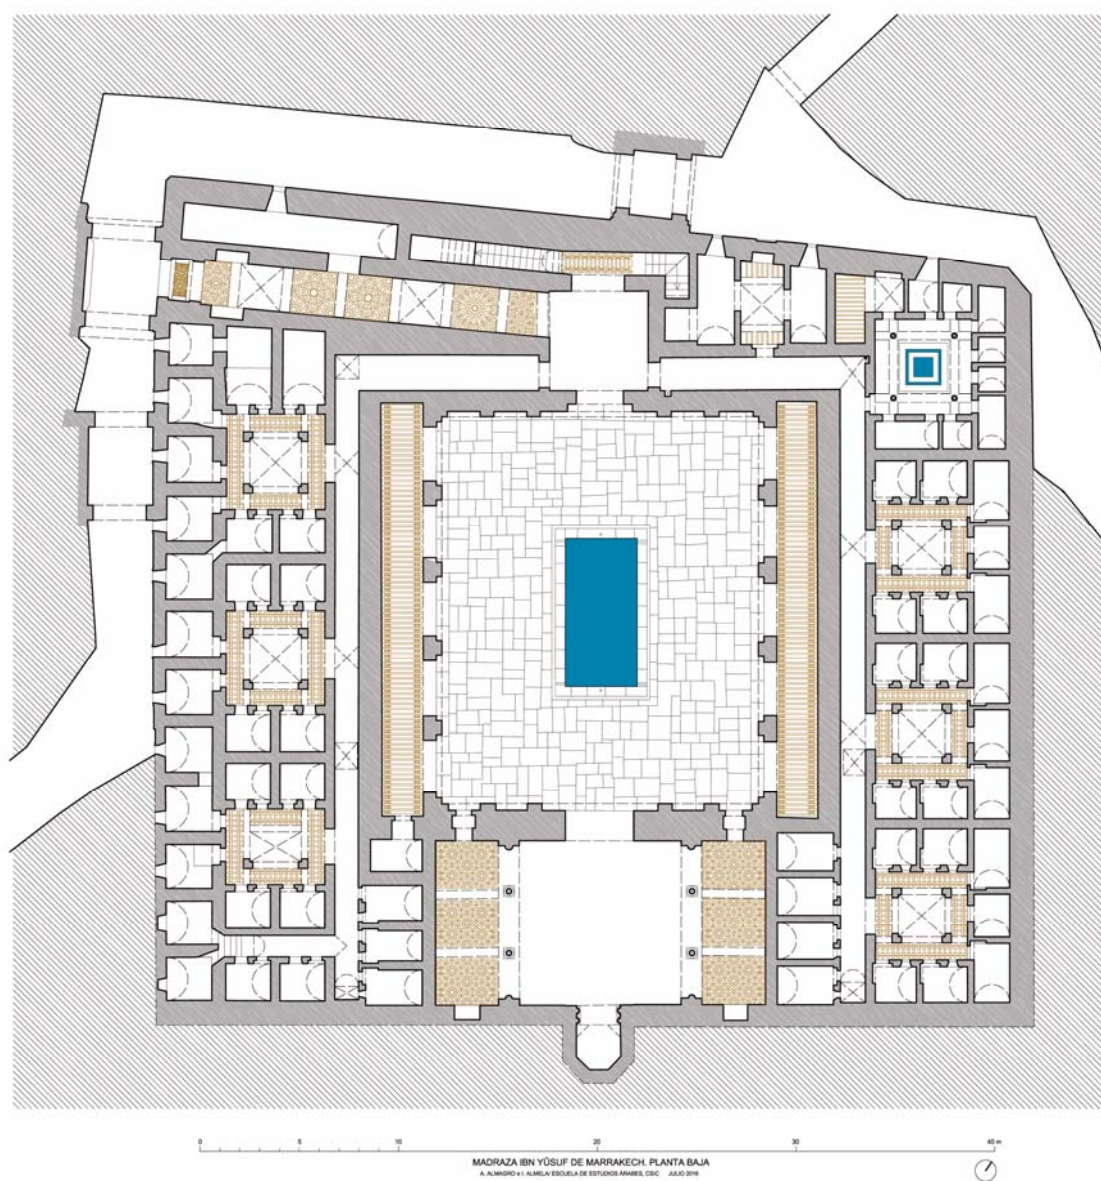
Madraza Ibn Yūsuf. Planta baja.
